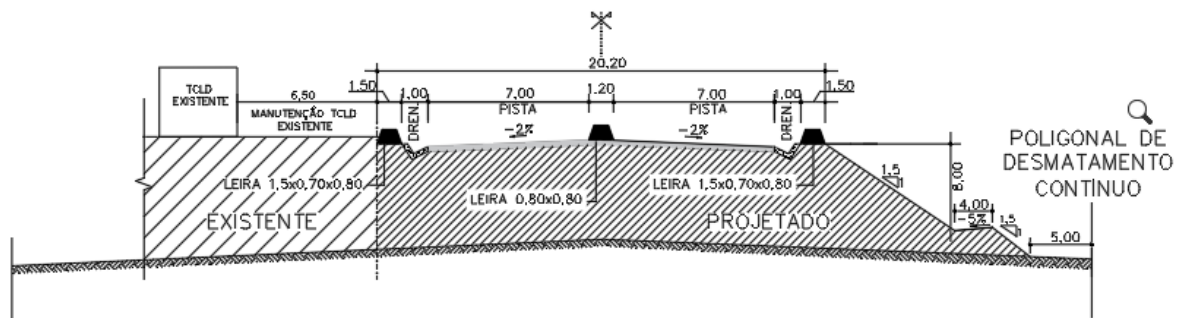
Vista da Seção Tipo Projetada da estrada – SEÇÃO DE ATERRO
